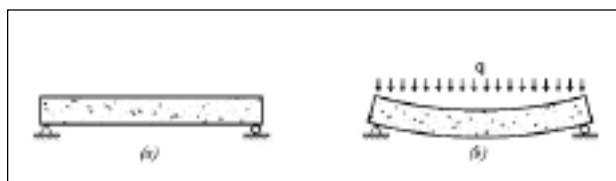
Viga a reforzar -(a) estado inicial -(b) viga cargada y deformada.
